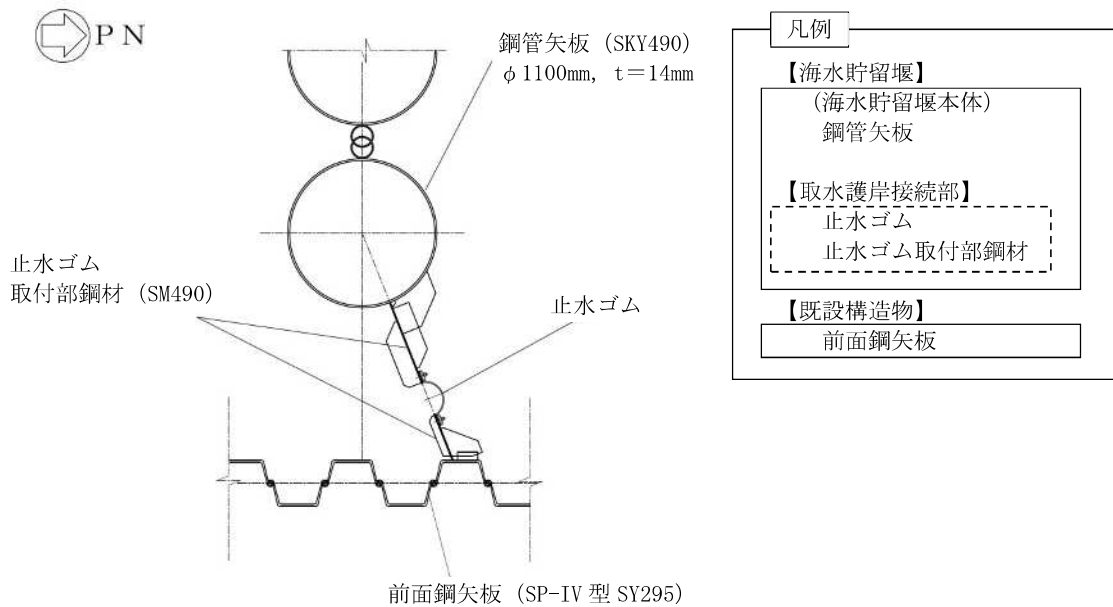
(2) 取水護岸の平面図 (A部拡大)
